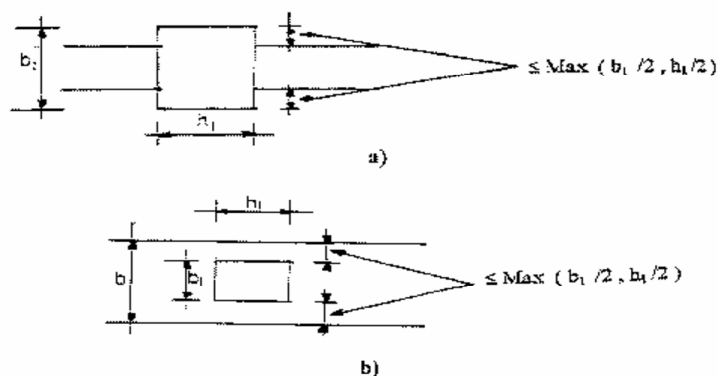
dimensionnement respecté pour les poutres selon RPA2003[25]
